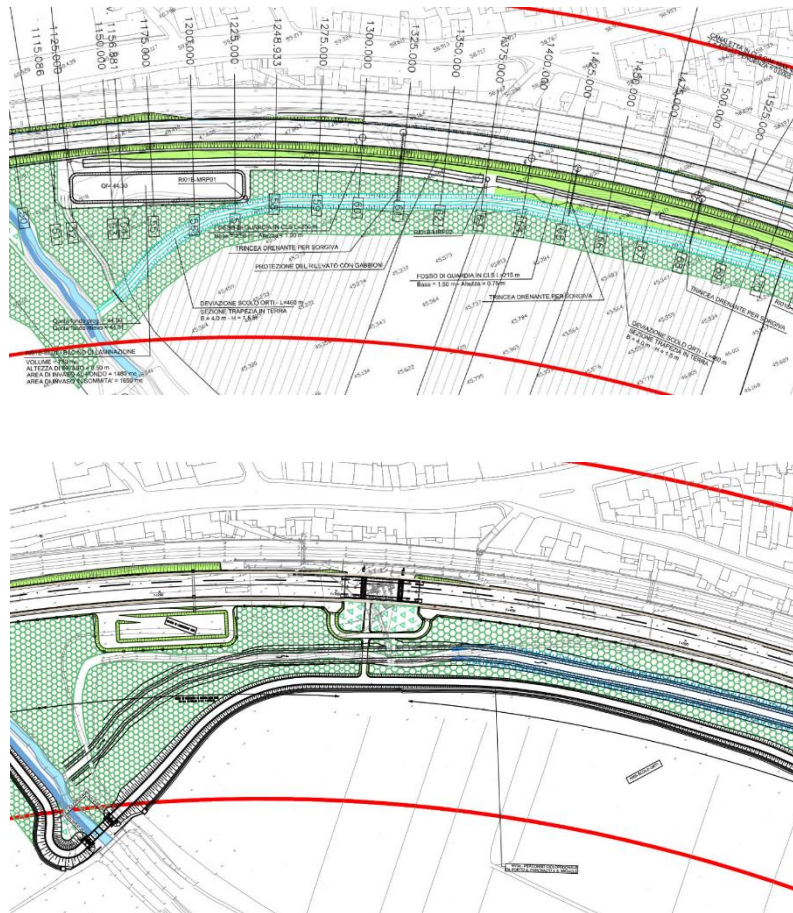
Planimetria di progetto delle opere a verde di PD e PE
